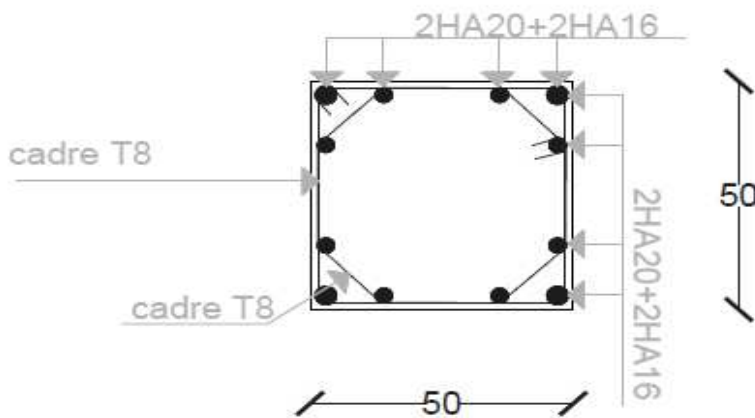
Schéma de ferrailage de poteaux carré50x50
